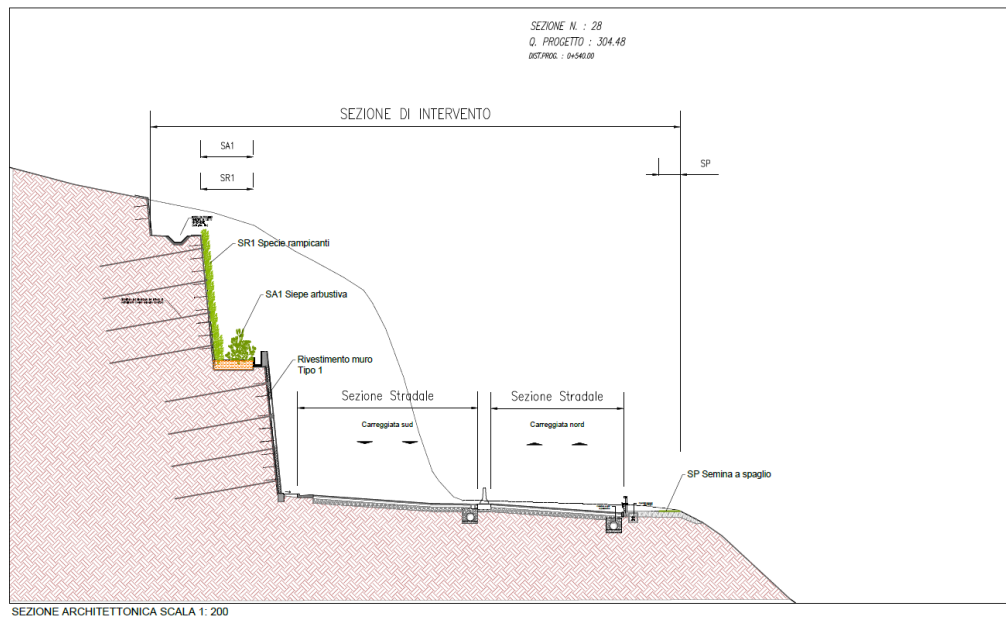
Sezioni tipo sistemazione trincea in roccia
